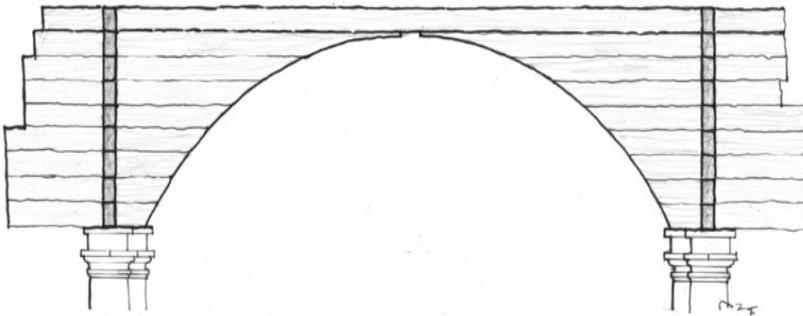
Elevación de los arcos con zapatas en saledizo. Viga principal superior, zapatas y capiteles fueron elaborados de madera. Dibujo: Luis Torres G., 2020.
